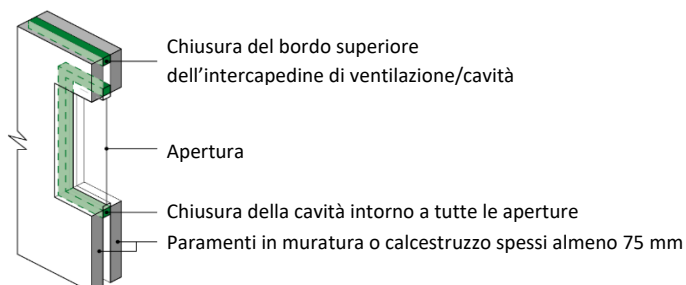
Esempio di parete con intercapedine di ventilazione/cavità estesa a più piani con barriere per cavità
